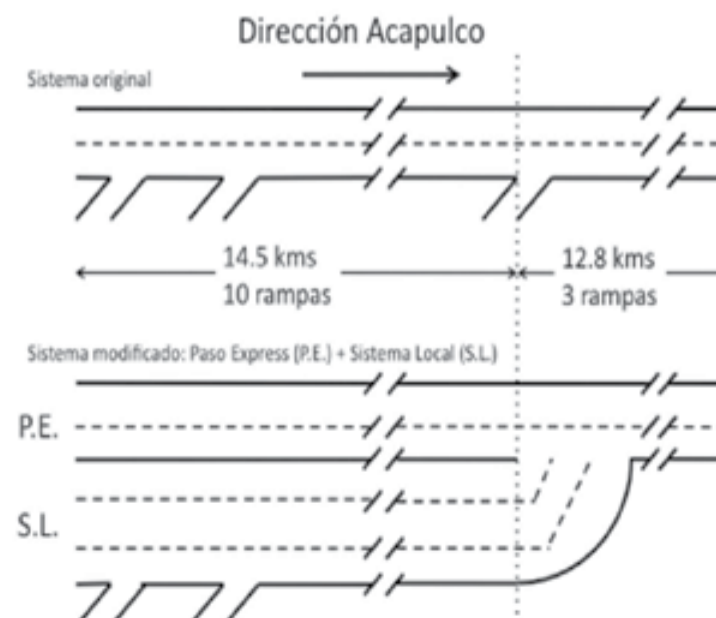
Esquema del libramiento de Cuernavaca y las modificaciones planteadas por el gobierno.
